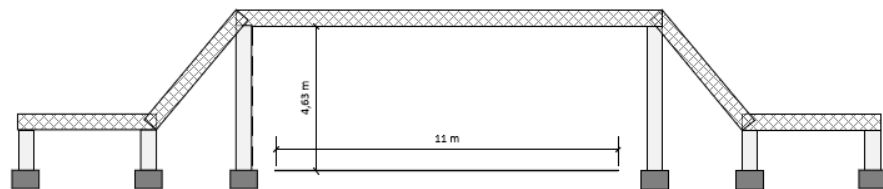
Overført faunapassage type A1F (tør), buebro i in-situ beton over 2 sporet vej.
